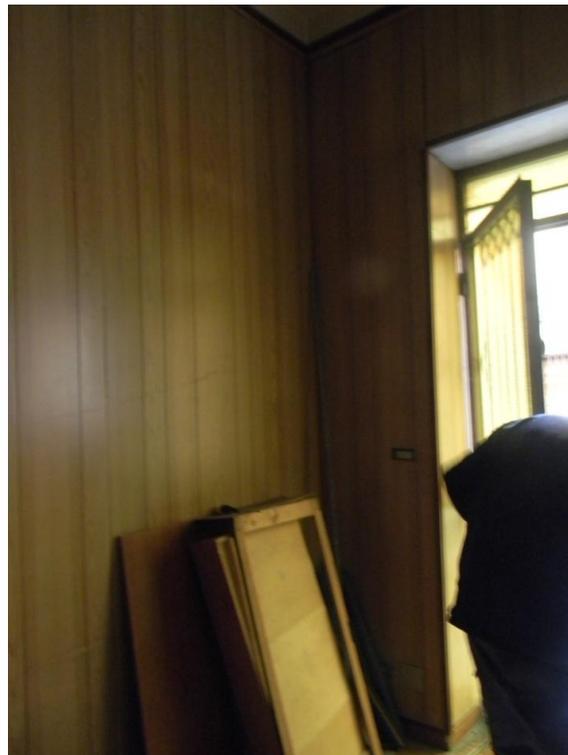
rivestimento delle pareti del vano ingresso al piano terra
